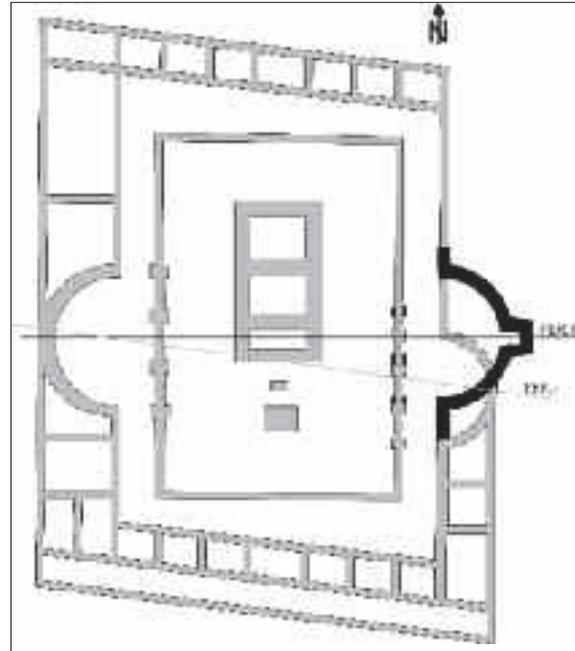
Planimetria schematica del distretto templare di St. Michael (DOLENZ 2007d, fig. 28).
